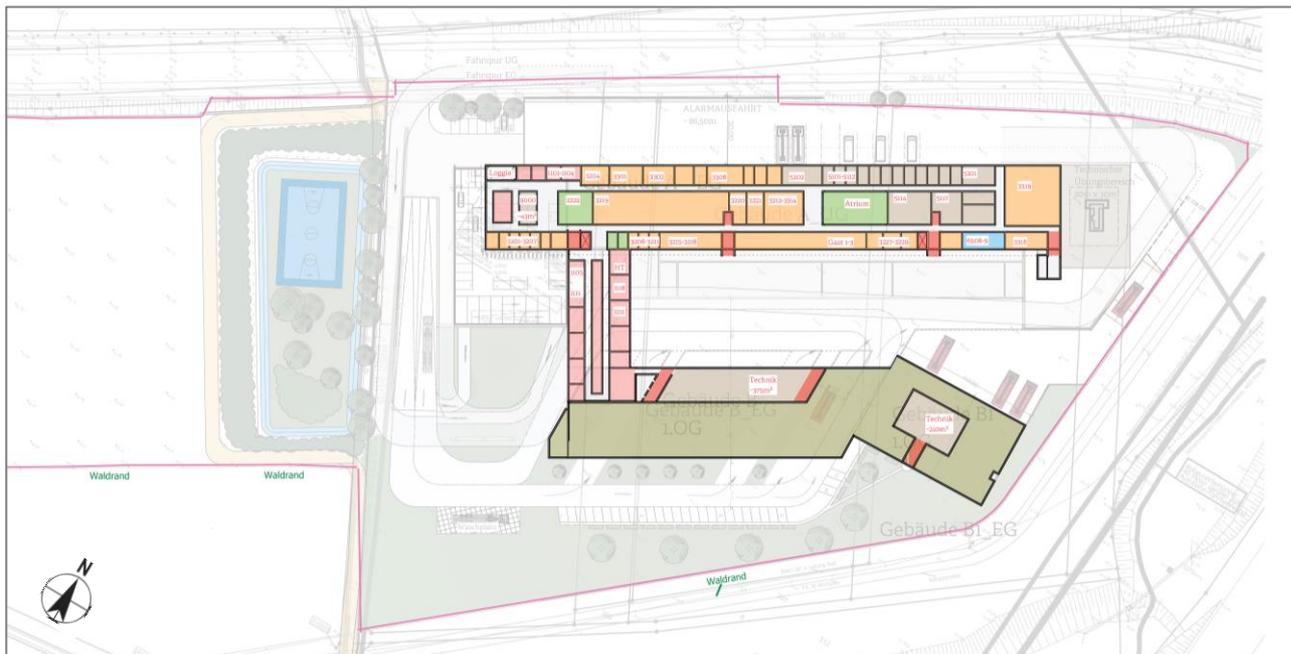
Ausschnitt Grundriss OG [19], zu untersuchender Standort der geplanten FRW Nord „Auf den Heunen“, Leverkusen (vgl. Fließtext), unmaßstäblich
